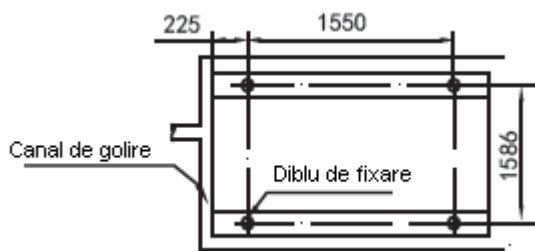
Schema dimensiunilor de instalare MC-SU60M/RN1L
